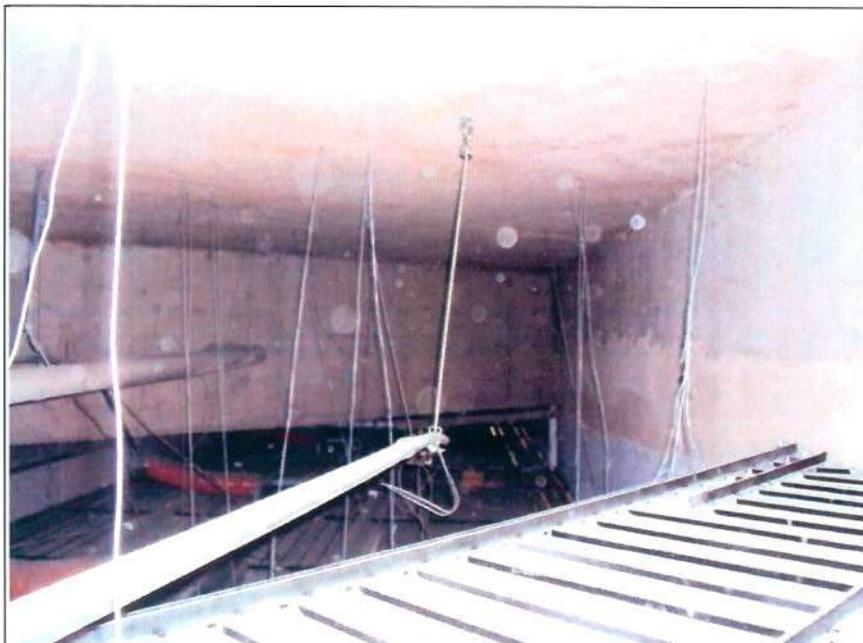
e 08: Vista do plenário, local com presença de fissuras.
